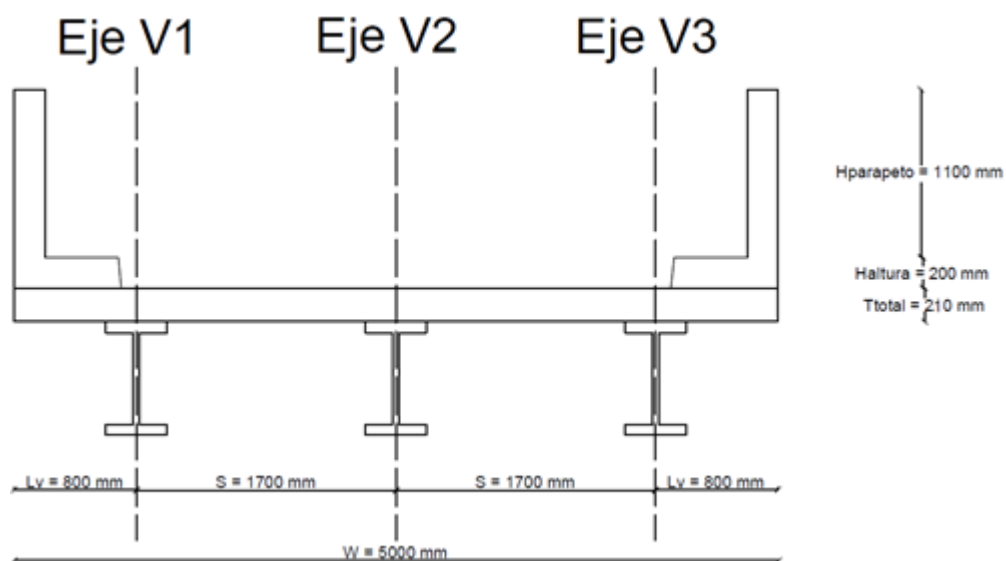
Sección transversal de la superestructura. Elaborado por: El autor.
